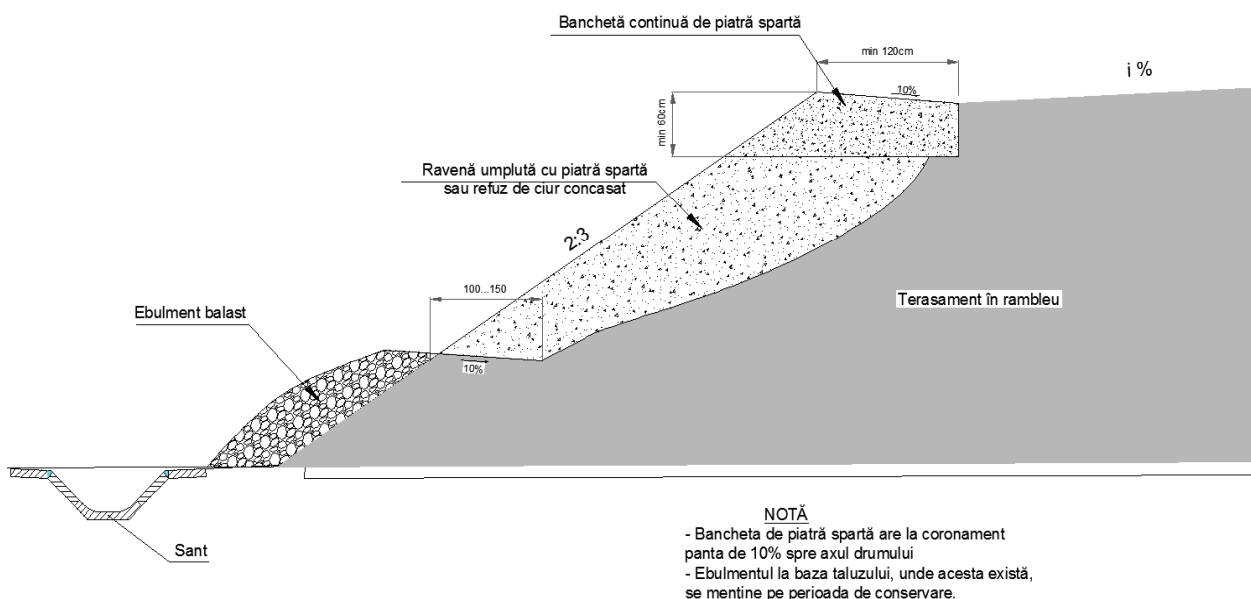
Închiderea ravenelor cu piatră spartă - zona fără structură rutieră
